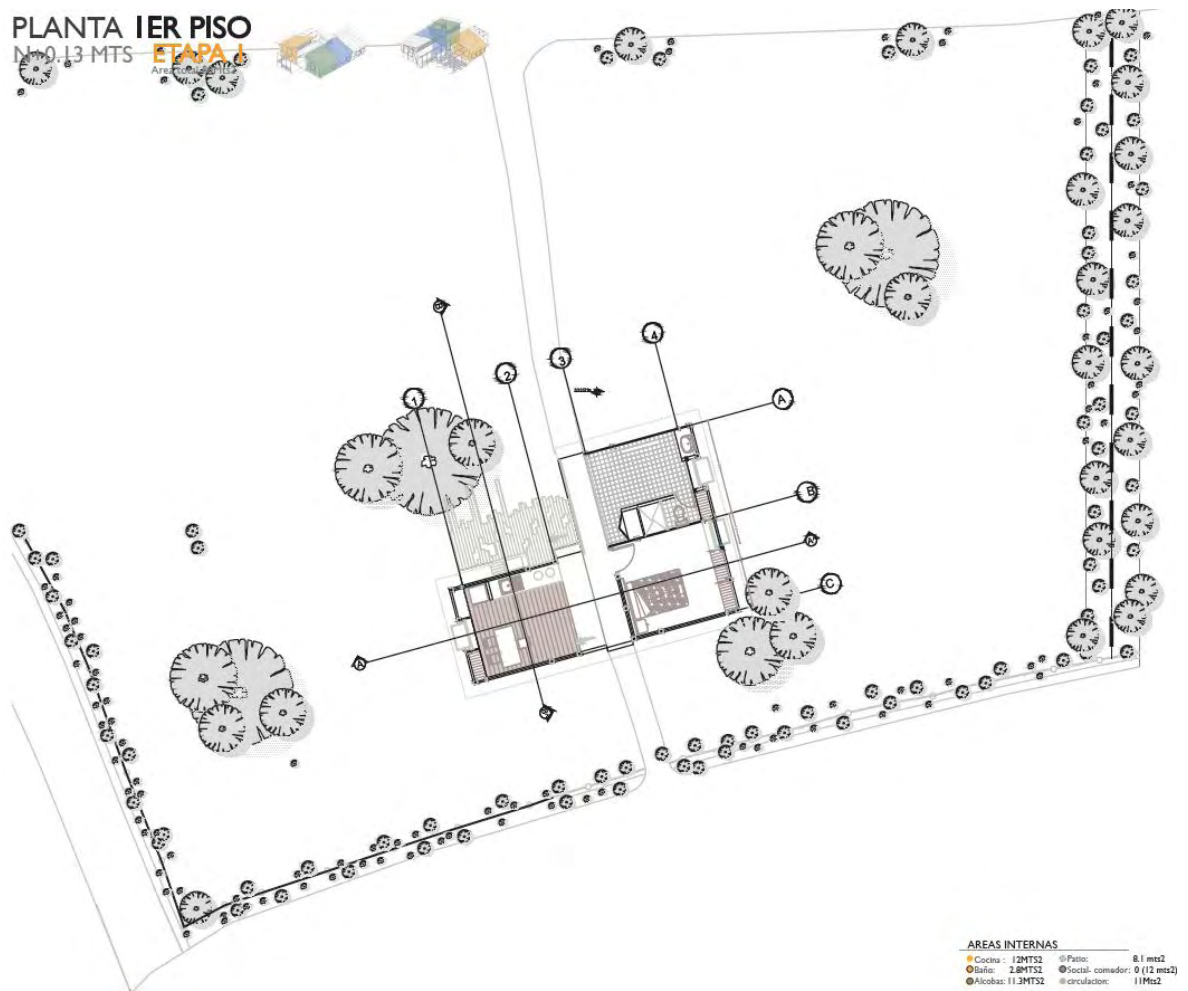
Planta I piso, primera etapa vivienda BI Fuente: propia
